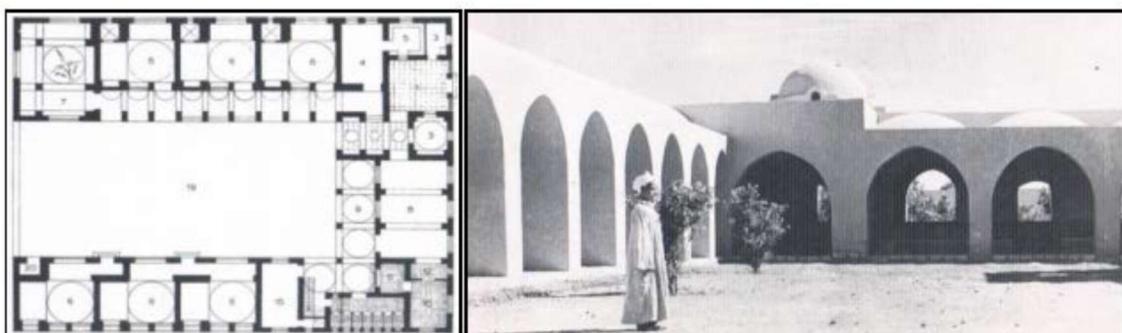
Plan, cour de l'école des filles. Source : FATHY Hassan. Op.cit., planches 99-101
